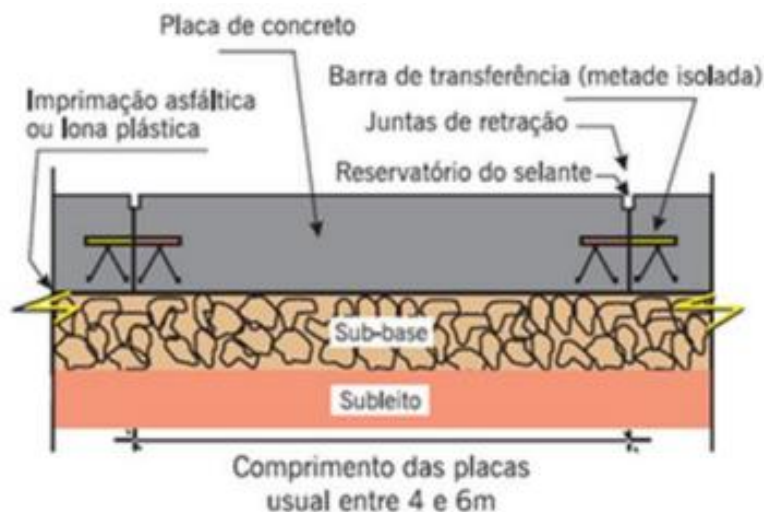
Secção transversal típica de Pavimento rígido. (1).
